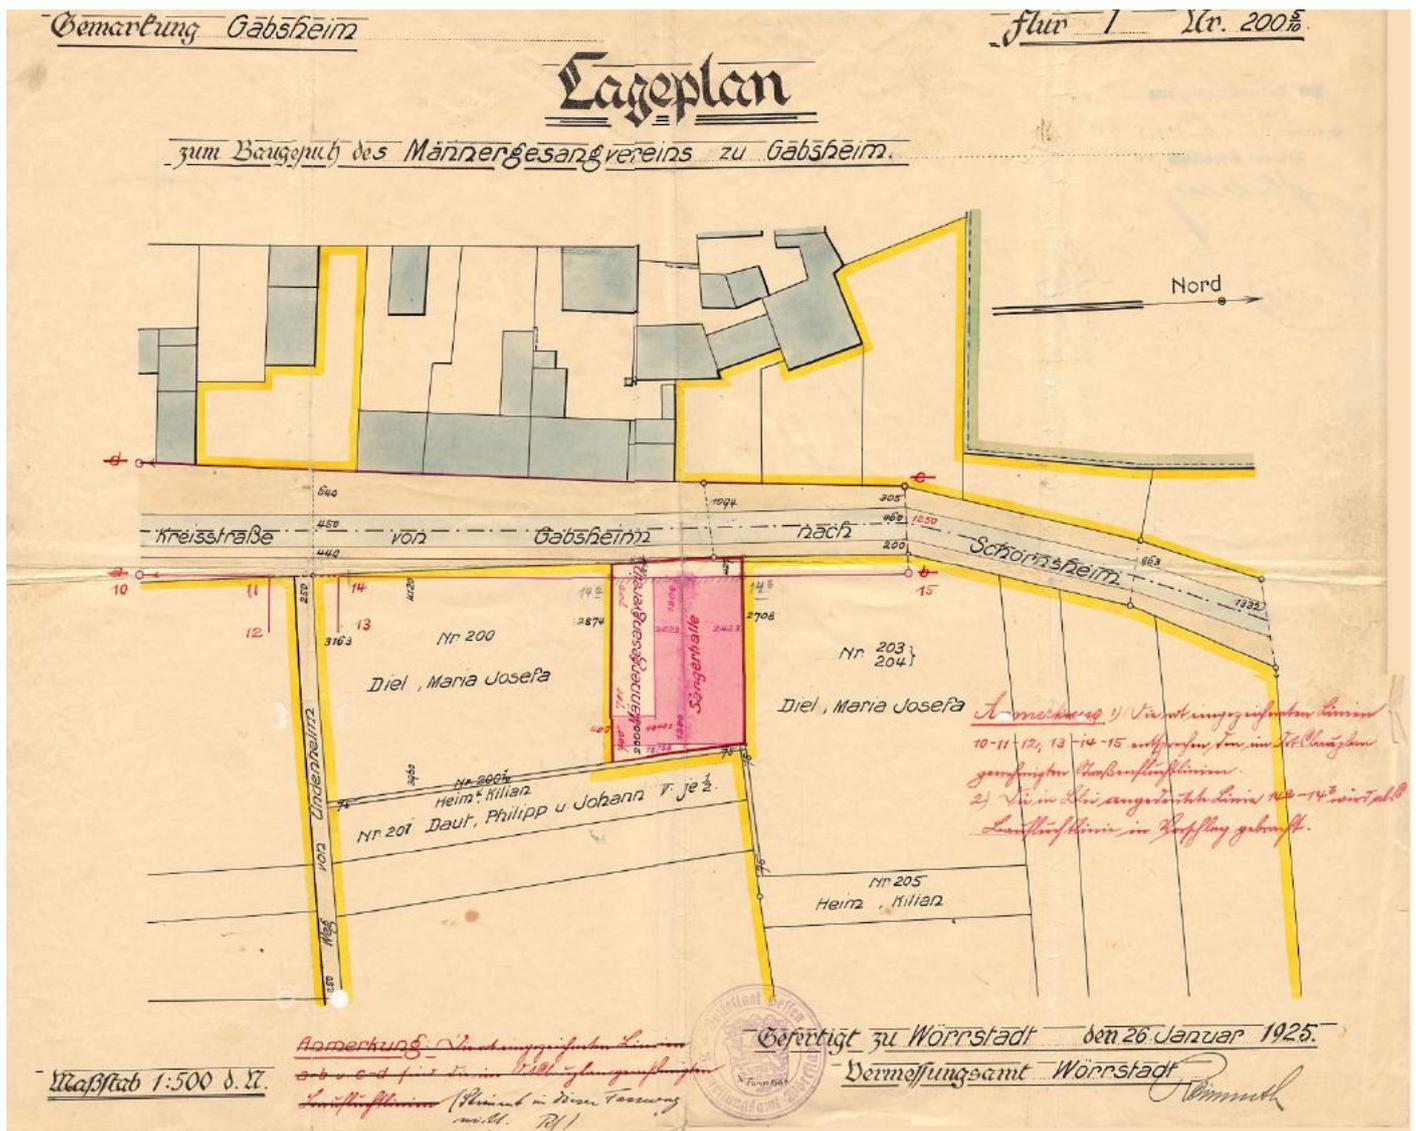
Lageplan der Sängershalle im Baugesuch von 1925
